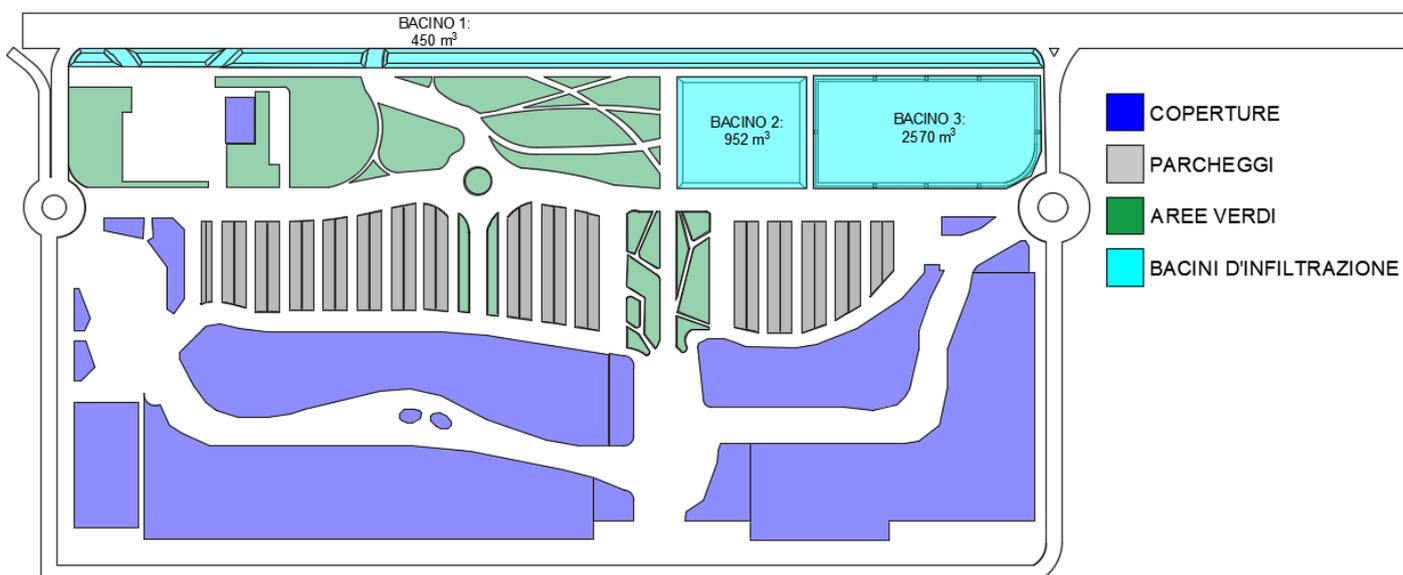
Individuazione dei bacini d'infiltrazione in pianta (realizzato con Revit 2023)
